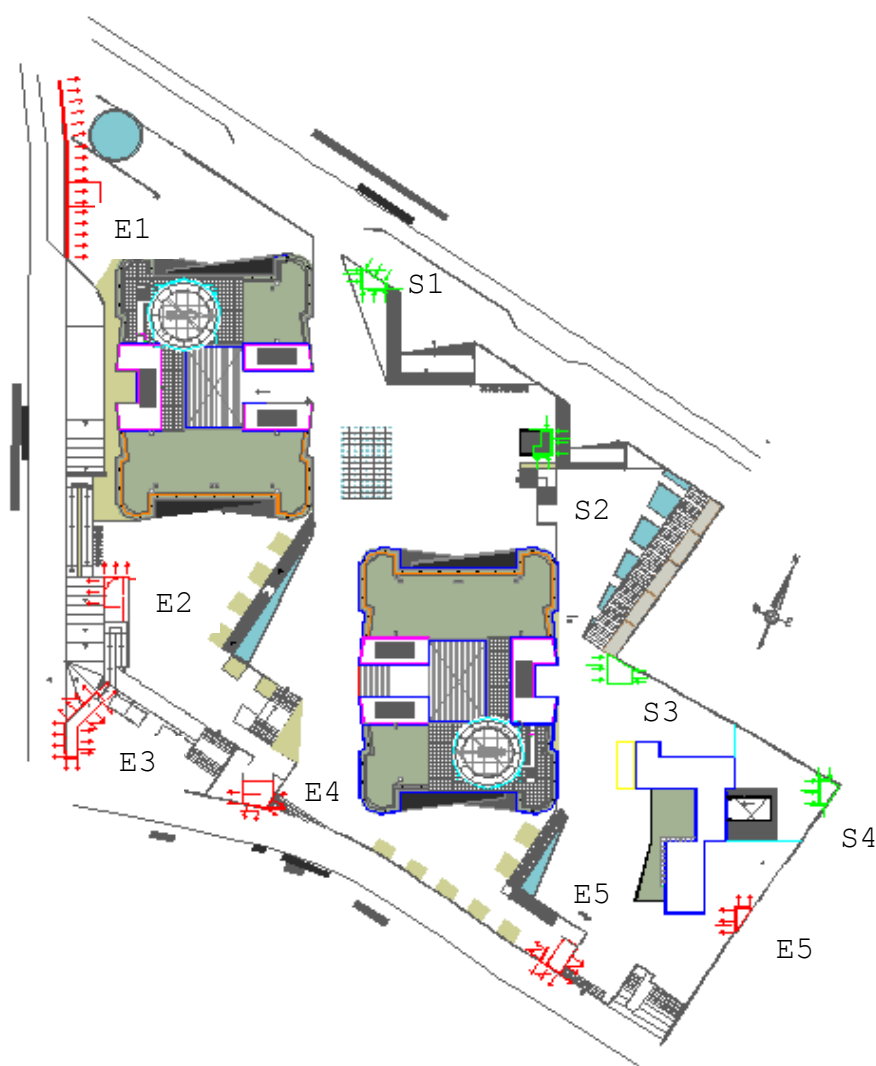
Vista en planta de la plaza del Proyecto y ubicación de conductos de ventilación [1]
